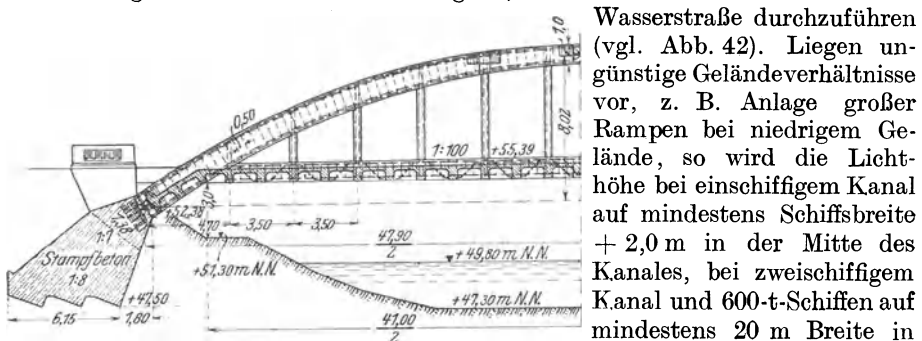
Längenschnitt einer Kanalbrücke in Eisenbeton.
